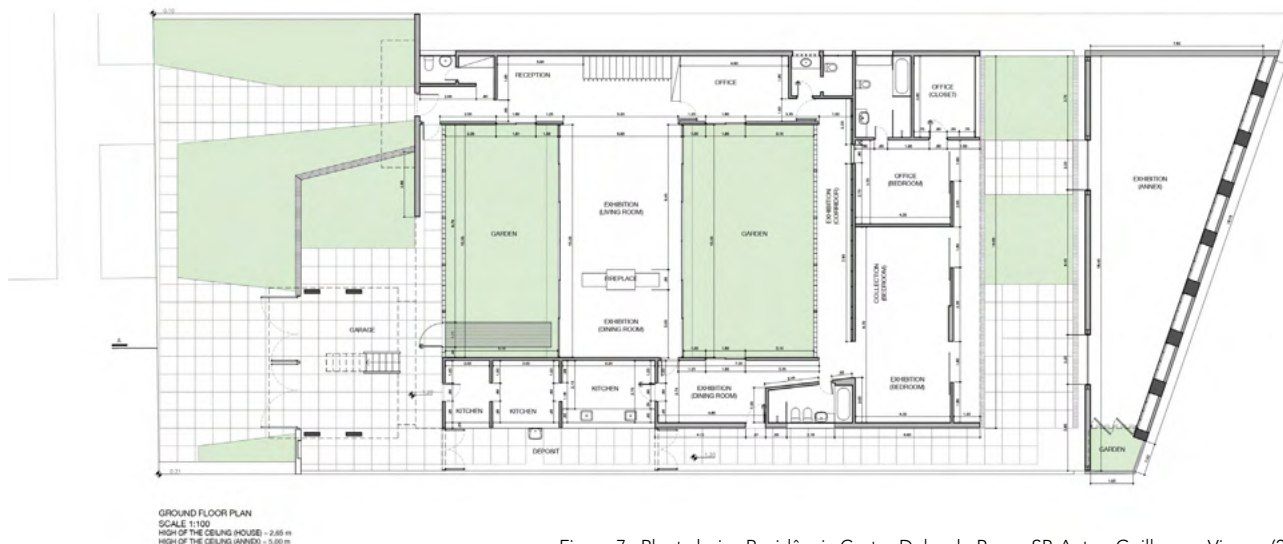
Planta baixa Residência Castor Delgado Perez, SP. Autor: Guilherme Vigano (2025).
